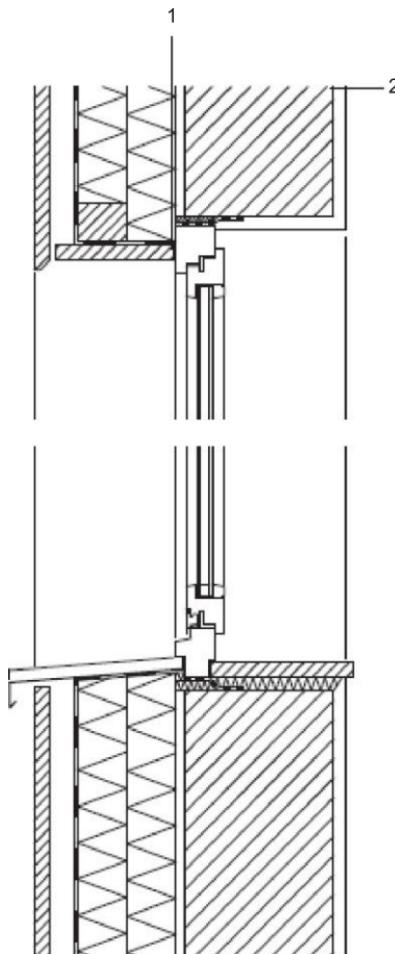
Стык окна с наружной стеной, защищенной навесной вентилируемой фасадной системой (вертикальный разрез):
